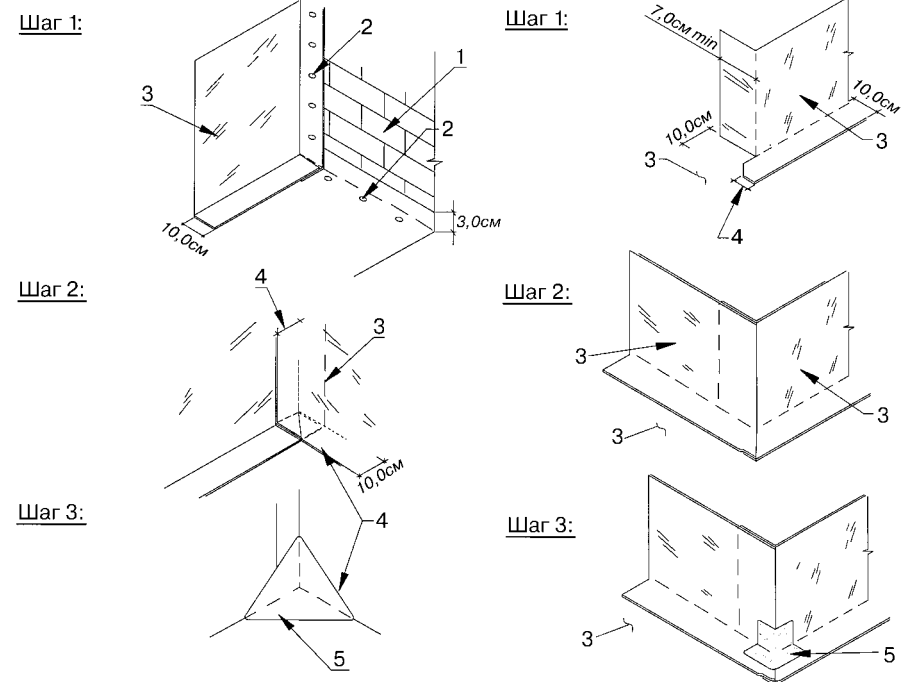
Устройство кровли во внутреннем углу парапета или стены (а) и на внешнем углу, например, вентилях (б) с использованием заводского элемента
